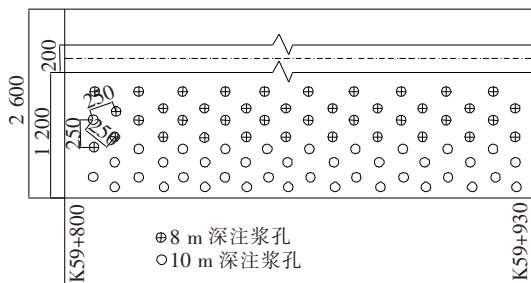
路面注浆平面图(除里程单位为 m 外,其余:cm)
